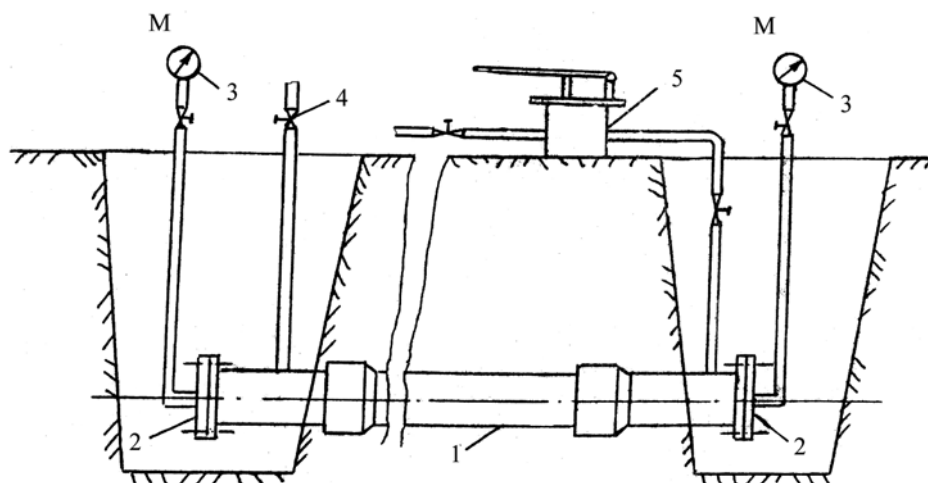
Схема гидравлического испытания трубопровода:
